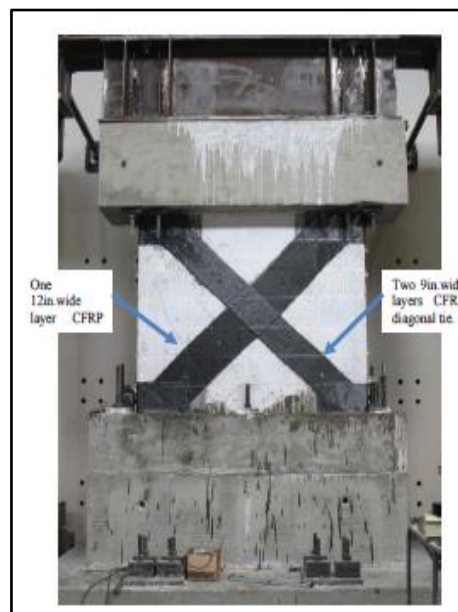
Vista frontal del Muro de Mampostería remodelado.
